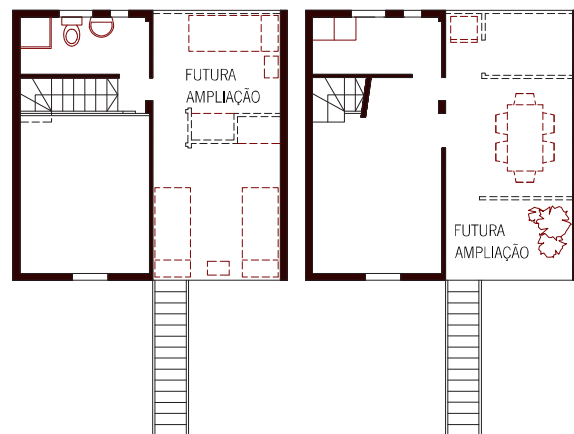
Plantas 3º e 2º piso - Quinta Monroy - ELEMENTAL
